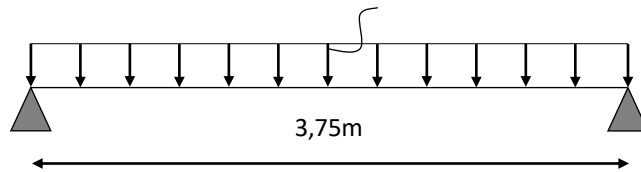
Schéma statique de la poutre de chaînage (ELS)
